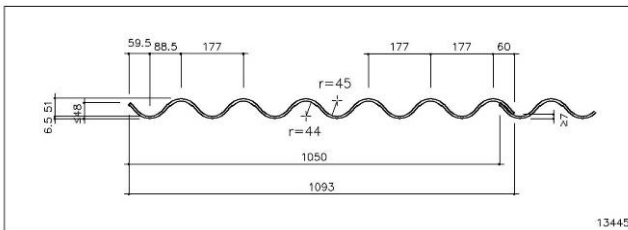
Plaque ondulée ECOLOR profil 177/51 – coupe onde montante gauche et onde descendante droite
